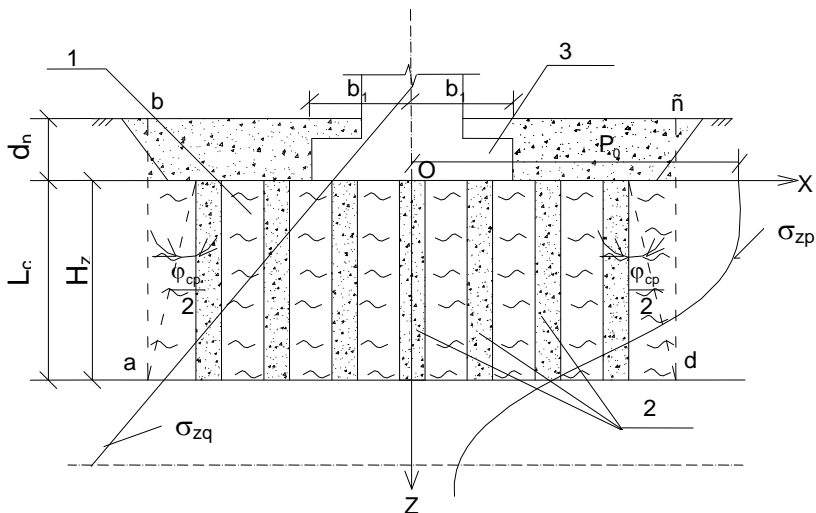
Схема к расчету основания, армированного вертикальными элементами: 1 – грунт пониженной прочности; 2 – армирующие элементы; 3 – плитный фундамент
